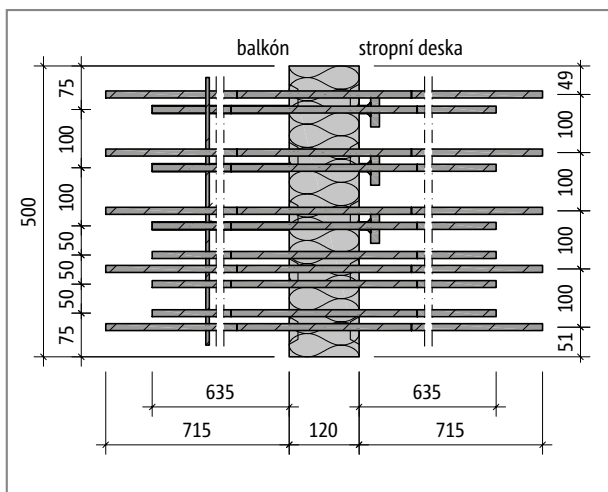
Schöck Isokorb® typ EXT30-L-V10: Půdorys prvku
